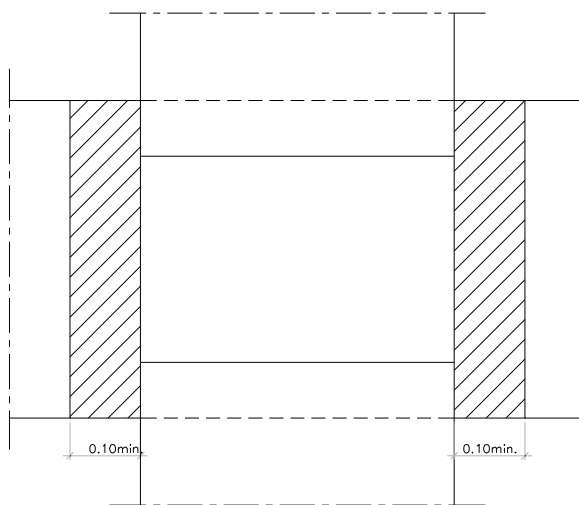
Joint plat sur terrasse accessible, raccordement sur un revêtement asphalte
